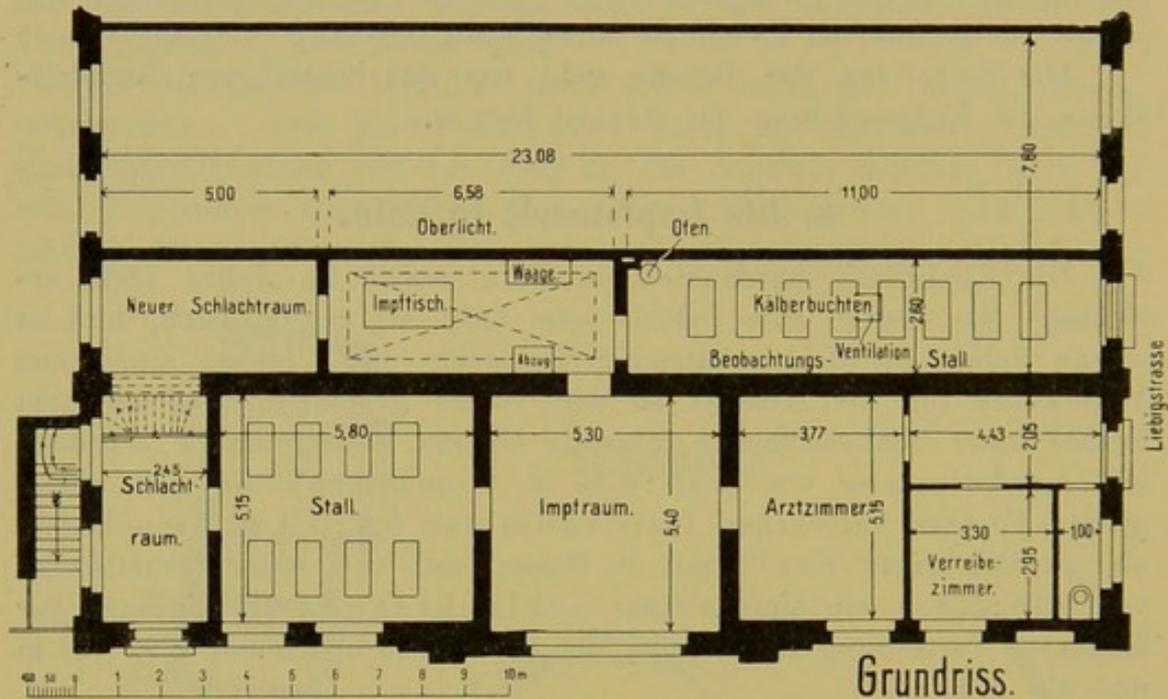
Impfanstalt in Cöln: Grundriß des Erdgeschosses.
